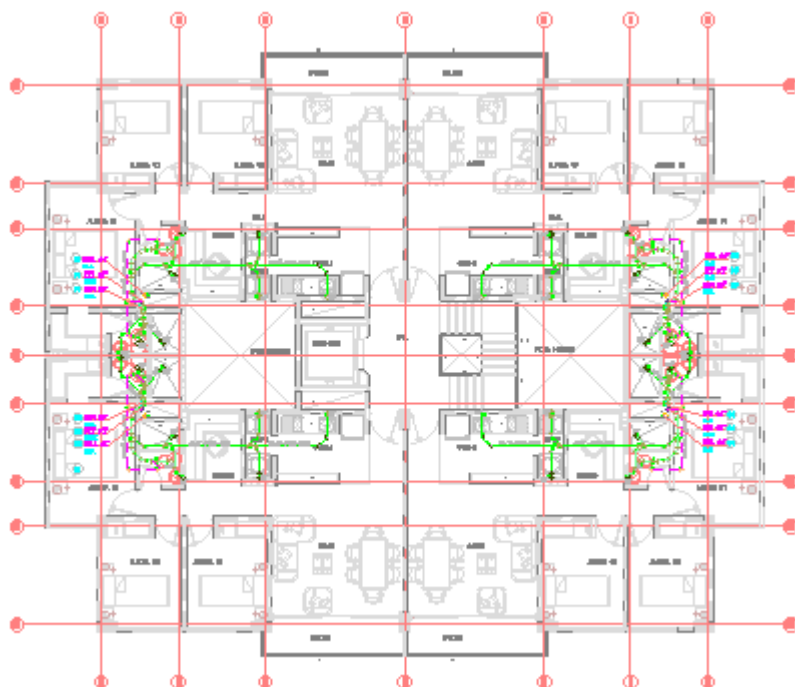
Plano Hidráulico. Suministro Piso 1
